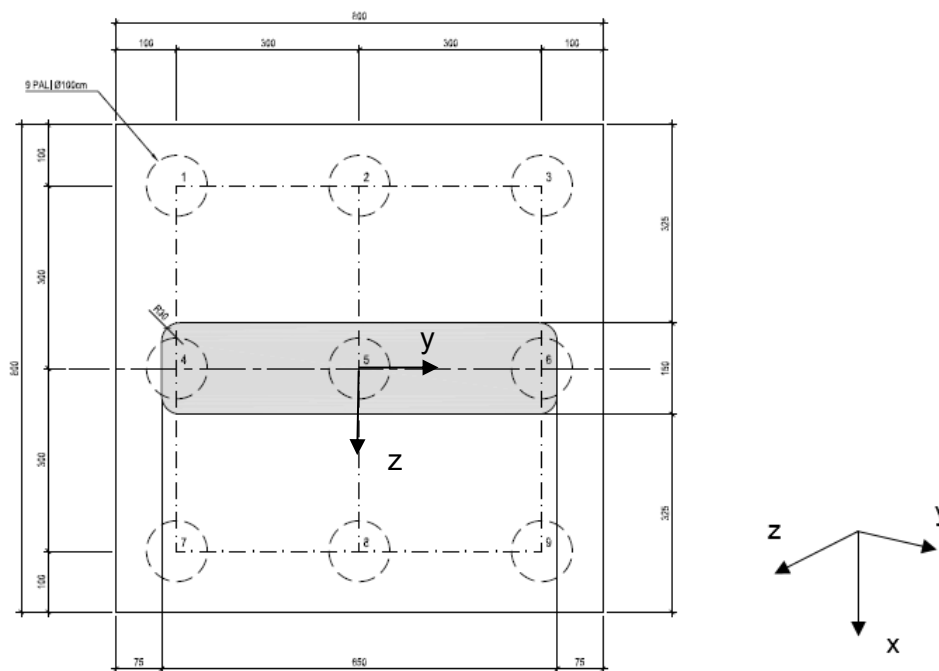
Pila 1: Pianta della palificata e sistema di riferimento.
